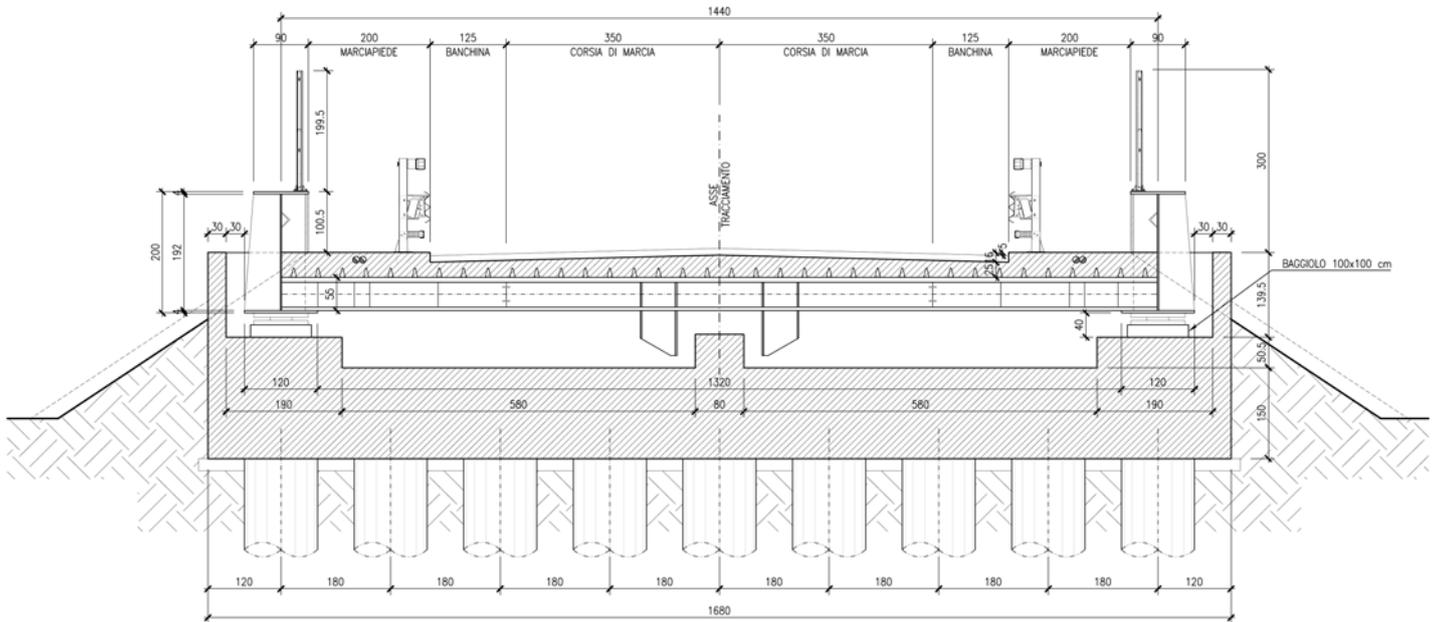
SEZIONI TRASVERSALI IMPALCATO.
